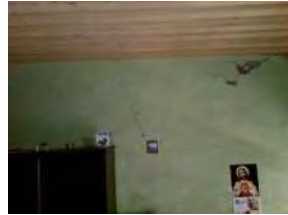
Grieta en vertical por la concentración carga en un punto del muro de la recámara (1).
